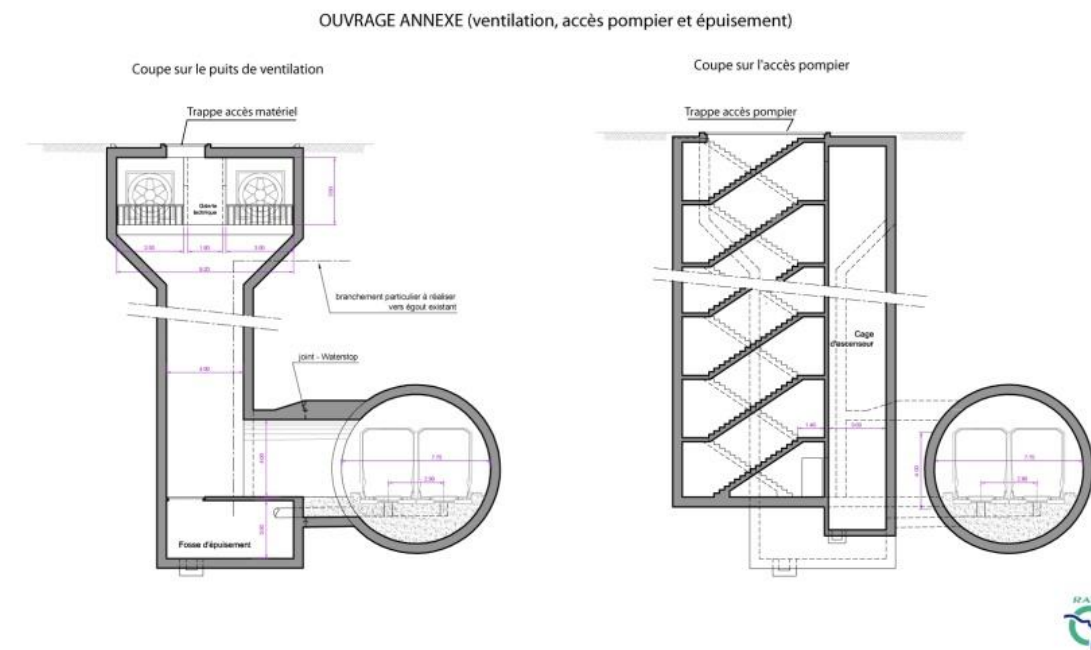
Coupes des ouvrages puits de ventilation et accès pompiers (Source : RATP)
